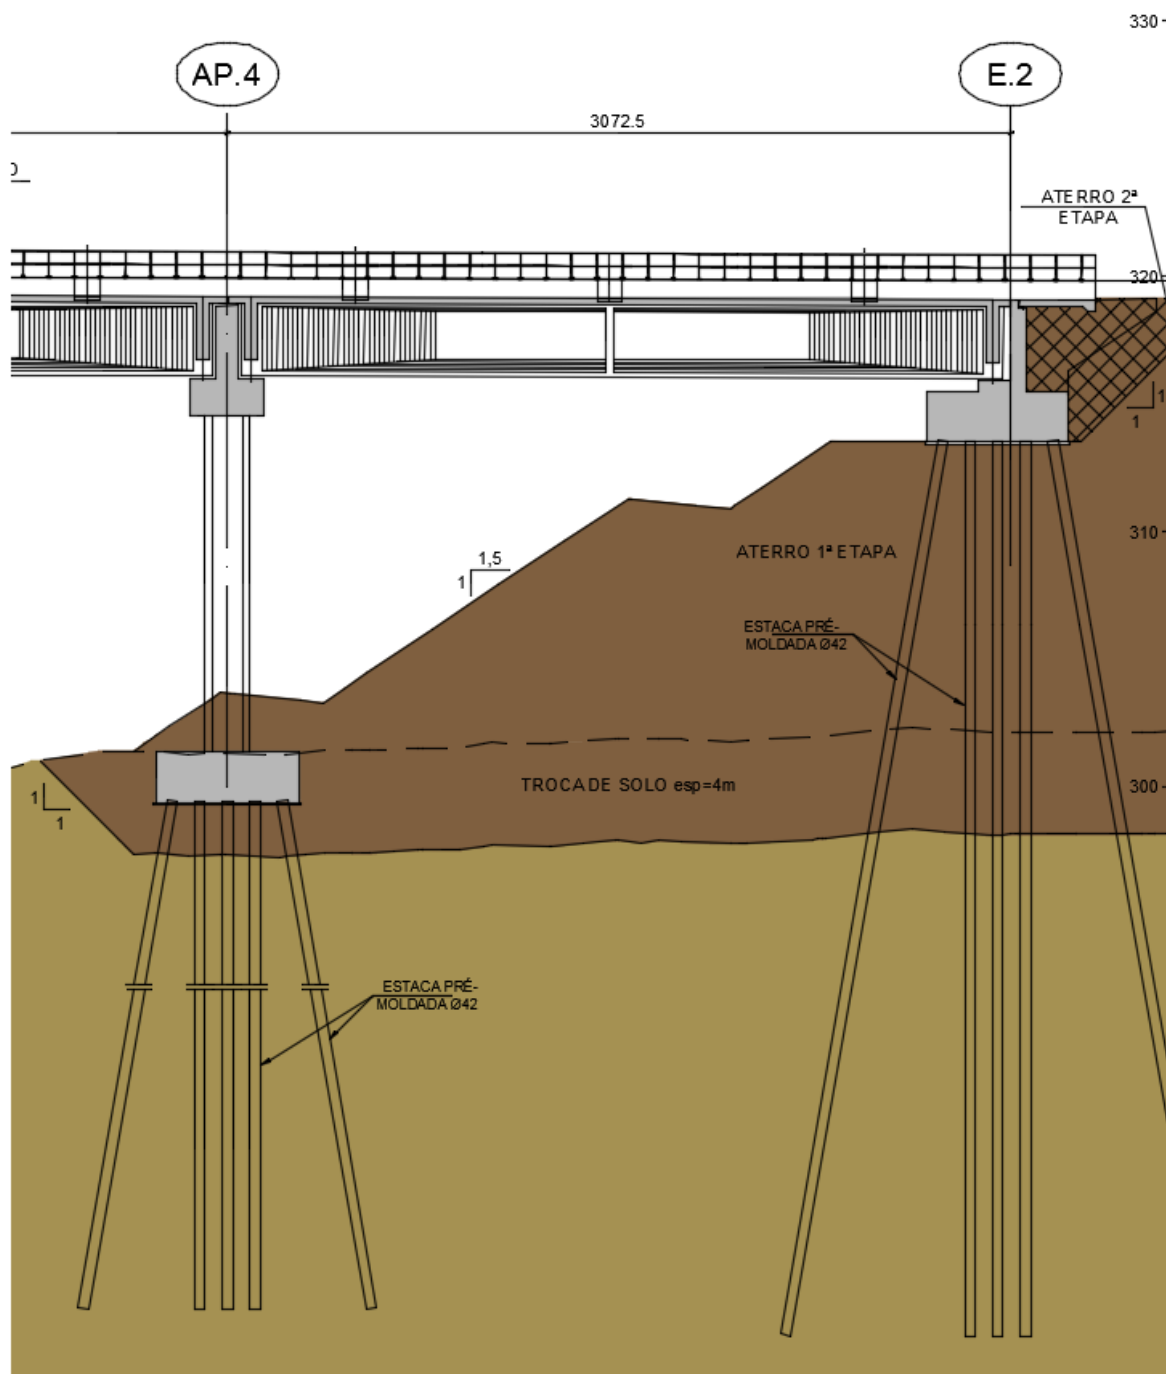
Elevação típica de um pilar e um encontro com fundação por estacas cravadas
